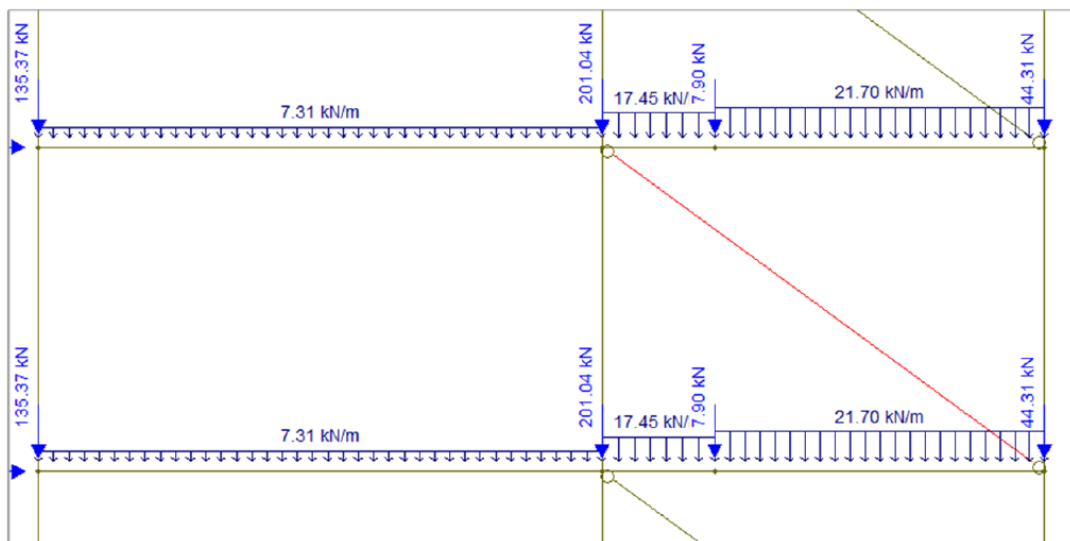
Detalhe das cargas acidentais e permanentes aplicadas nos pavimentos do pórtico 1
